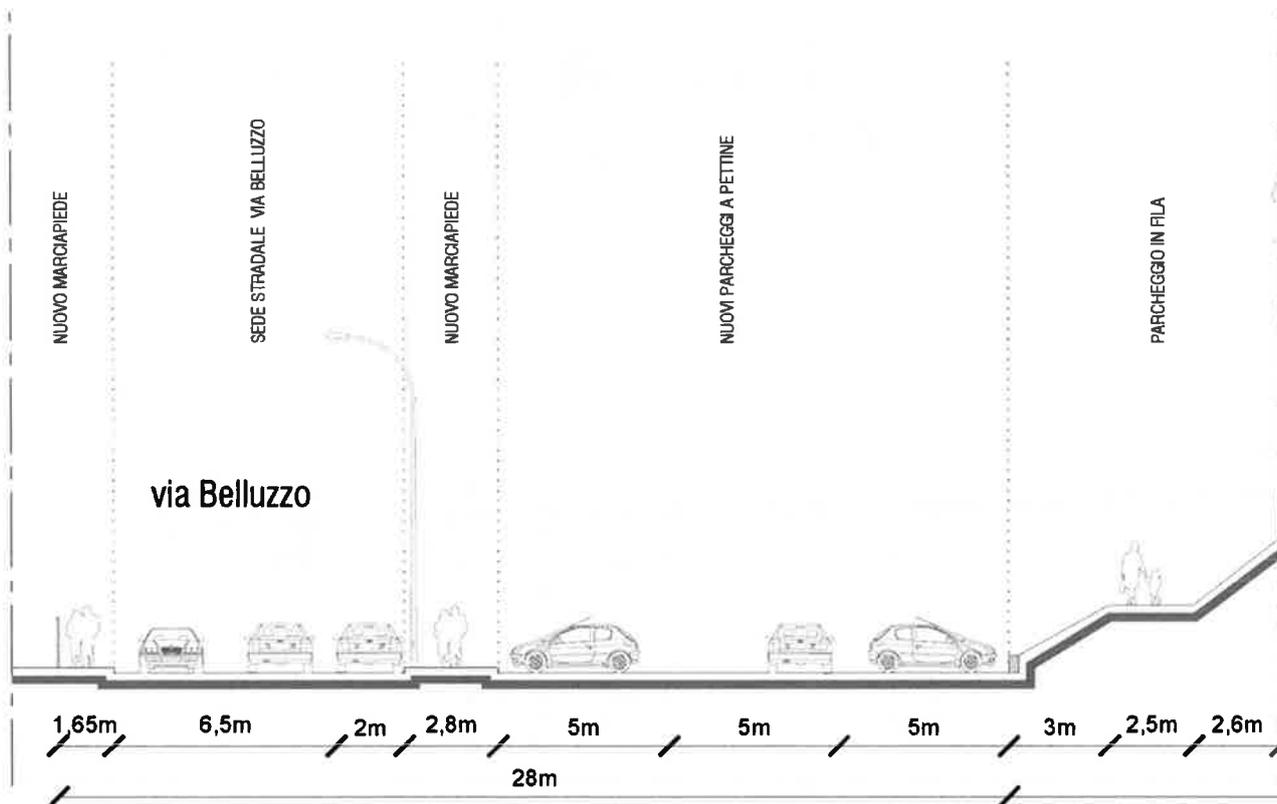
Sezione E-E estratta dalla tavola n. 9 del P.d.R. dell'ambito di valorizzazione B12_ scala 1:250.
